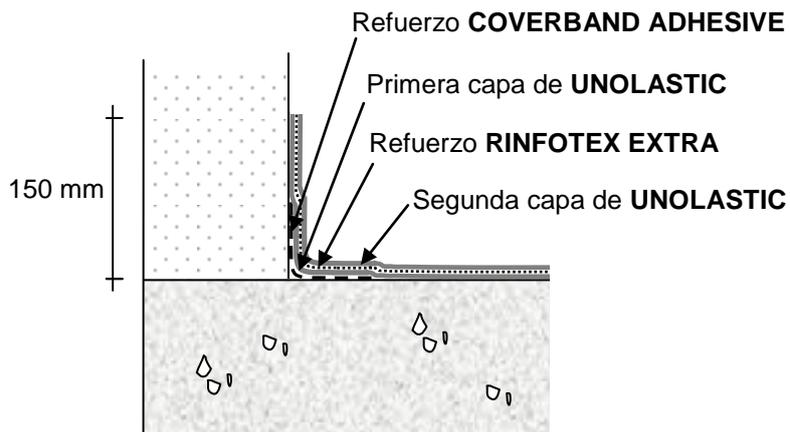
Detalle de encuentro entre elementos horizontales y verticales.
